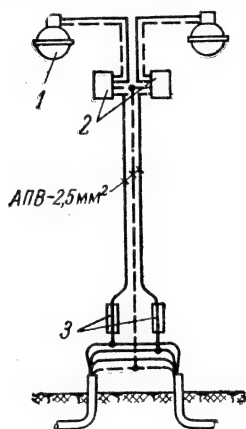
Схема подключения двух светильников с лампами ДРЛ, установленных на трубчатой опоре с кабельным вводом.
